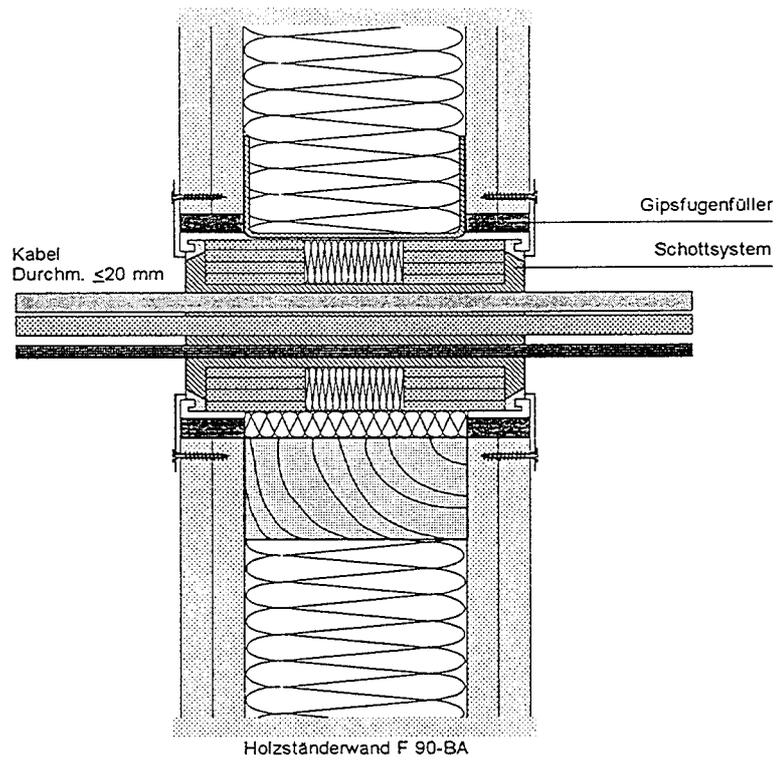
Kabelschottsystem als Plattenschottelement in Holzständerwand F 90-BA
